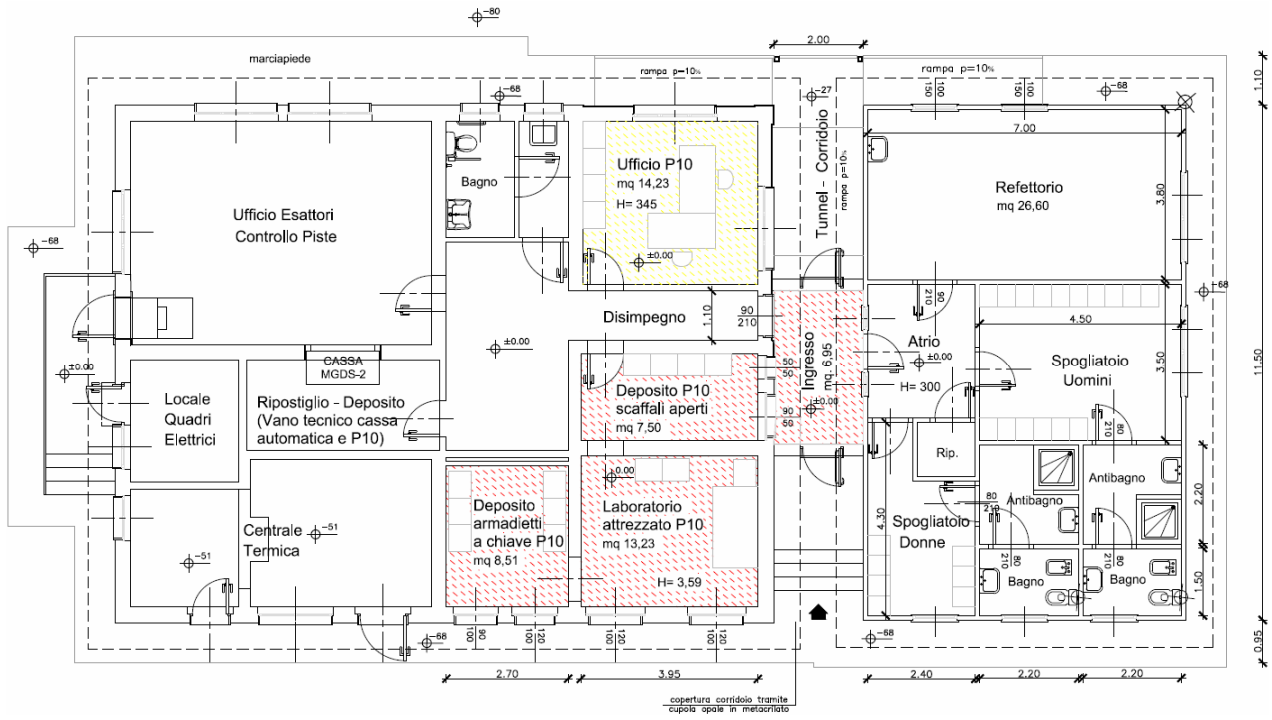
Pianta del fabbricato di stazione: progetto di ristrutturazione (in rosso i locali oggetto di modifiche, in giallo i locali soggetti a variazione di destinazione d'uso).
